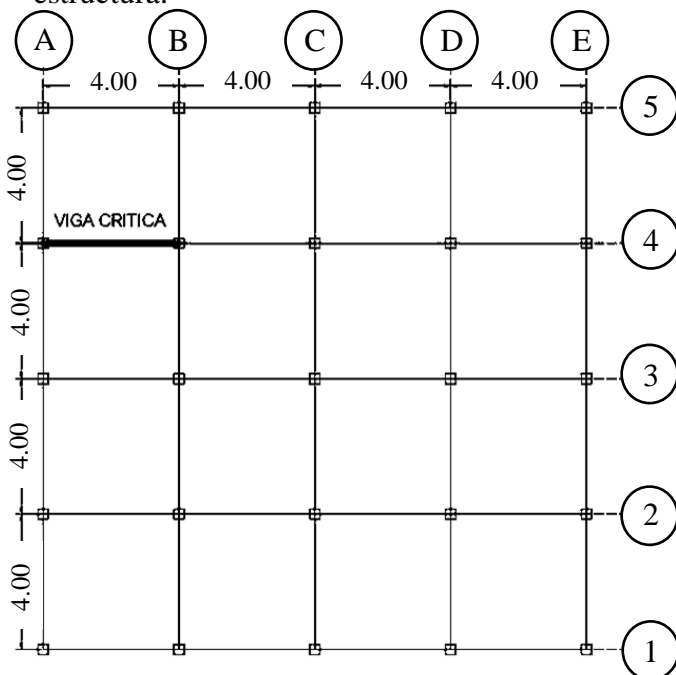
Esquema visto en planta de estructura, y viga crítica (Viga Eje AB-4) unidad (m). Escala 1:250. Fuente: Autores
